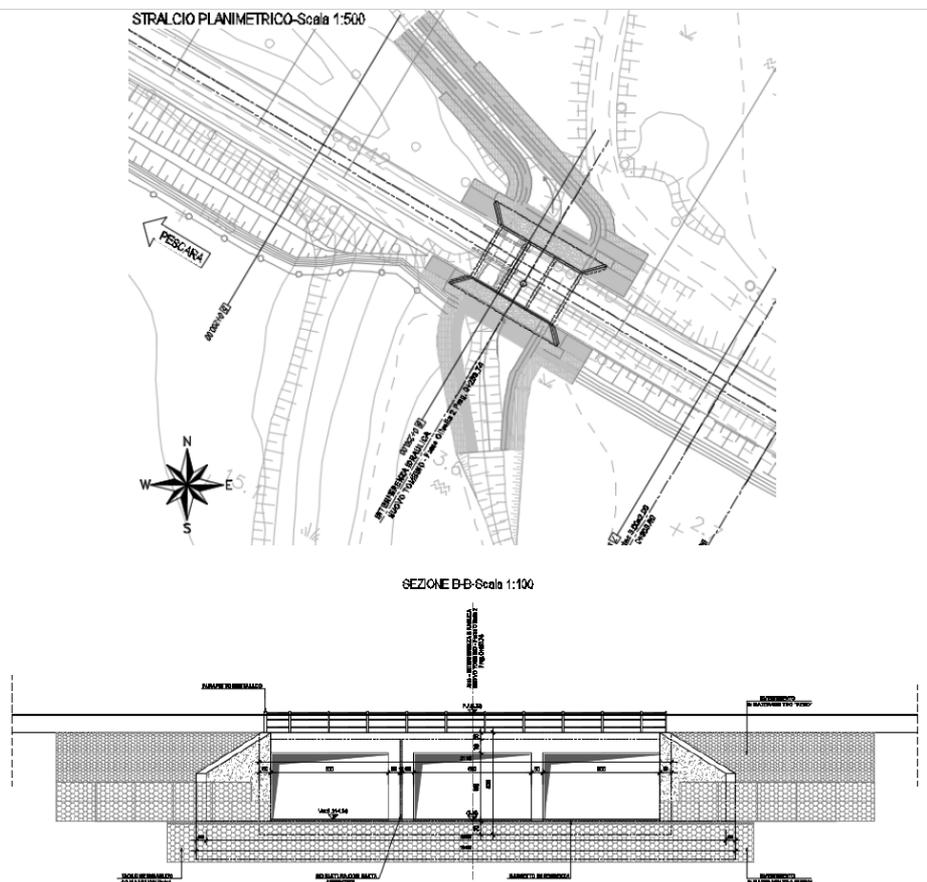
Stralcio Planimetrico e Sezione longitudinale
